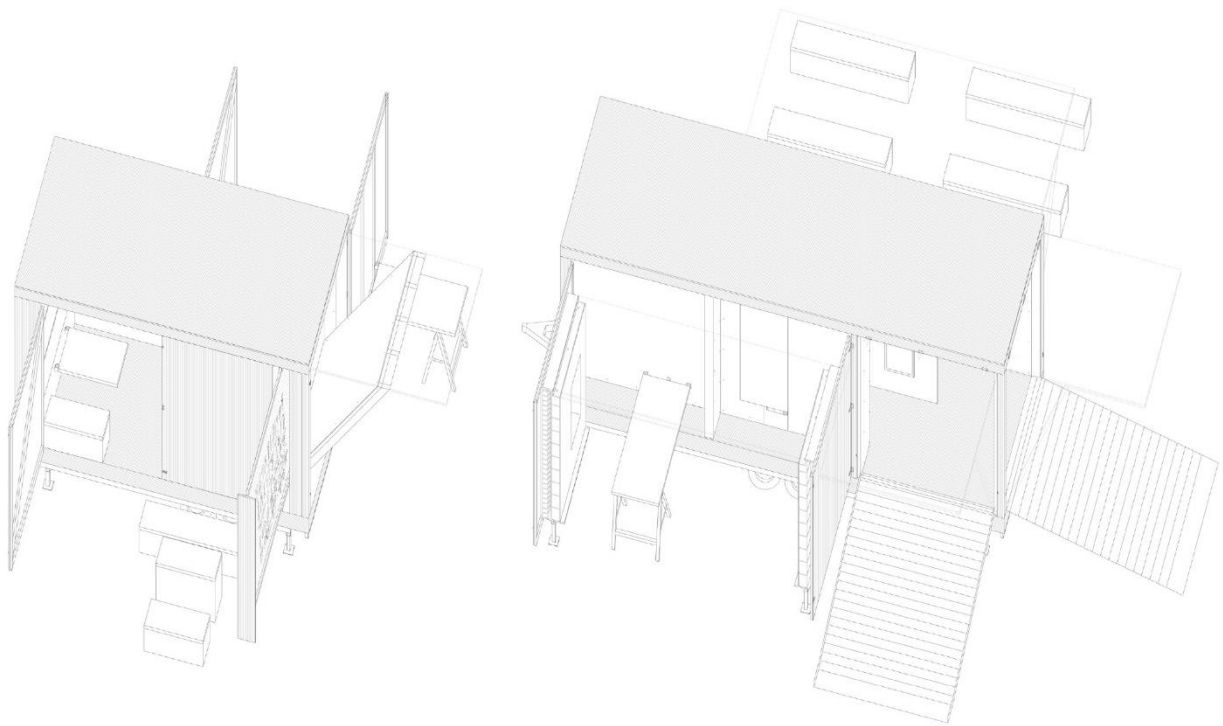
Etapes de construction d'une des deux parties du projet itinérant
